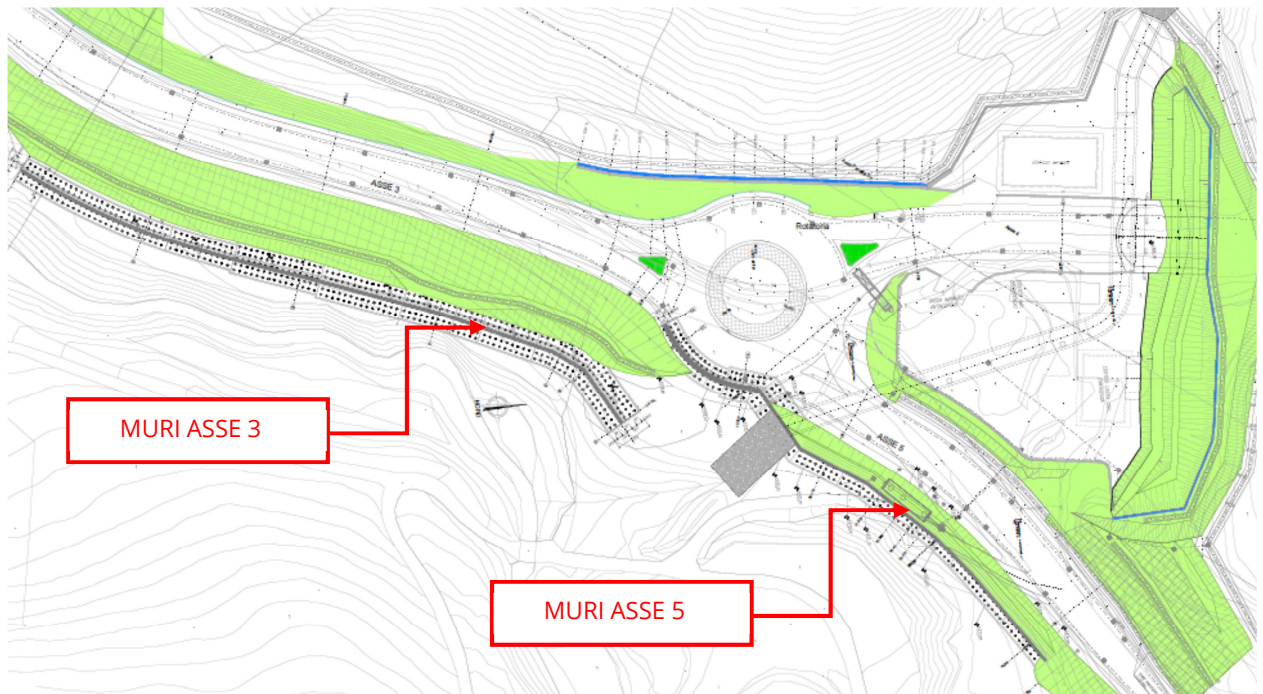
Stralcio planimetrico muri Asse 3 e Asse 5.
